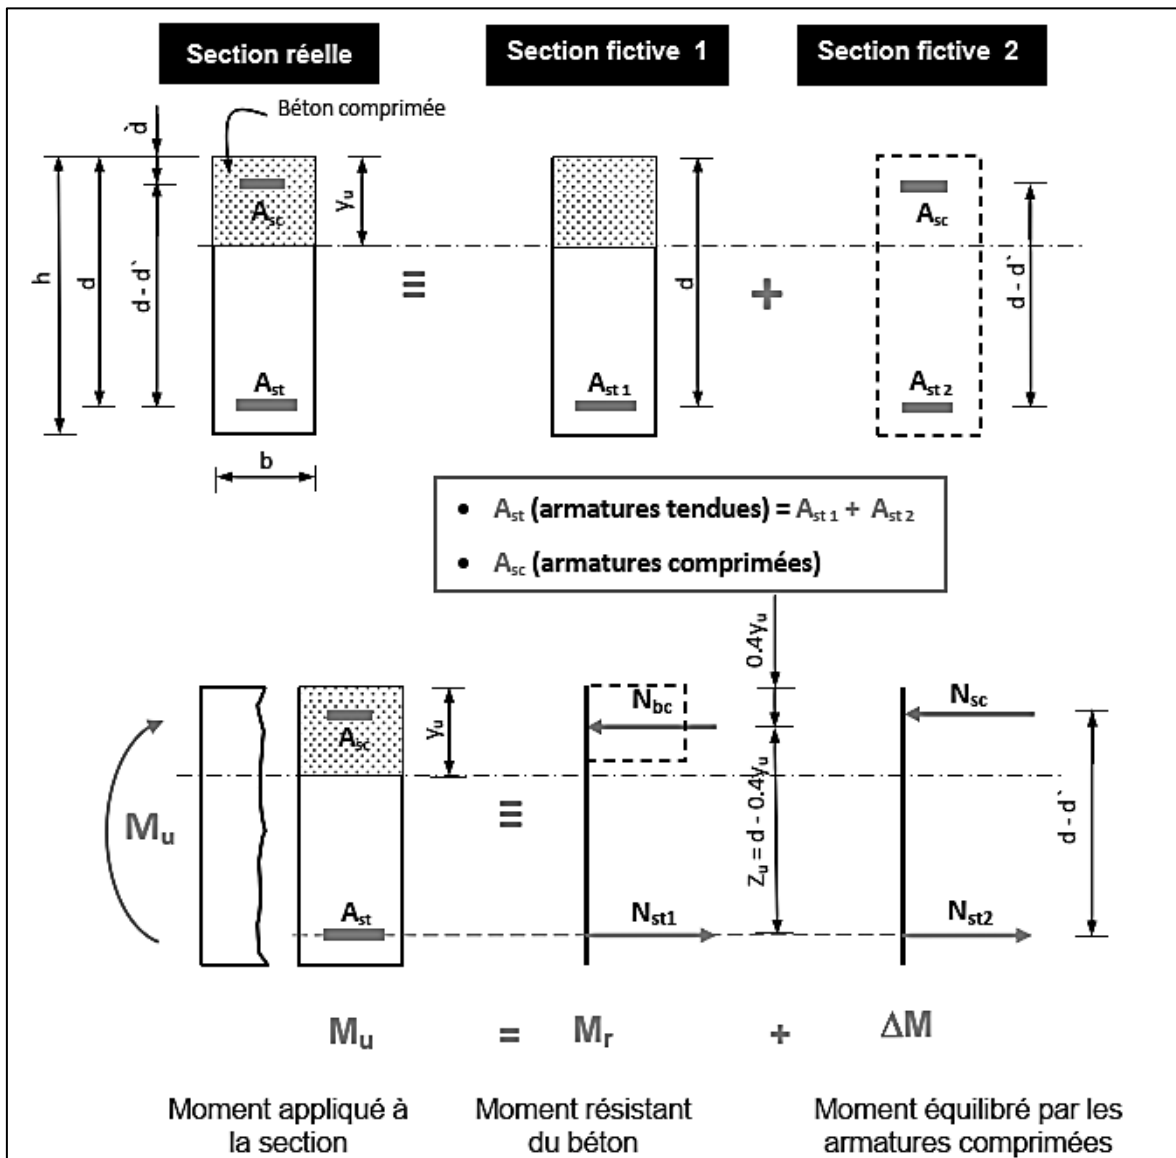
Principe de calcul à l'ELU d'une section rectangulaire avec aciers comprimés
